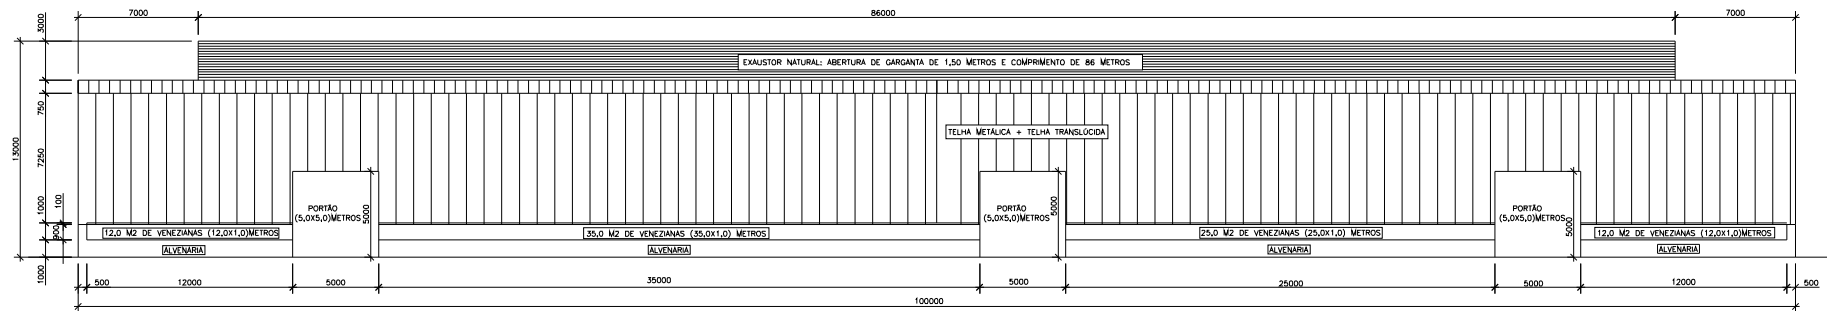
Fachada lateral do pavilhão industrial (SILVANI, 2005, p.63)
